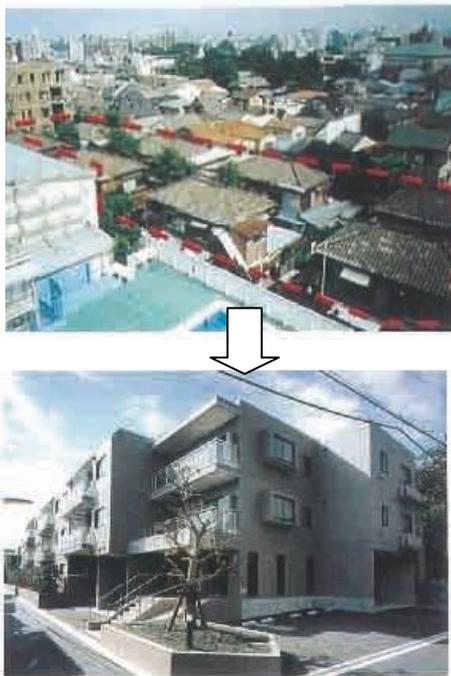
Rencana persiapan kota dalam menanggulangi bencana.
